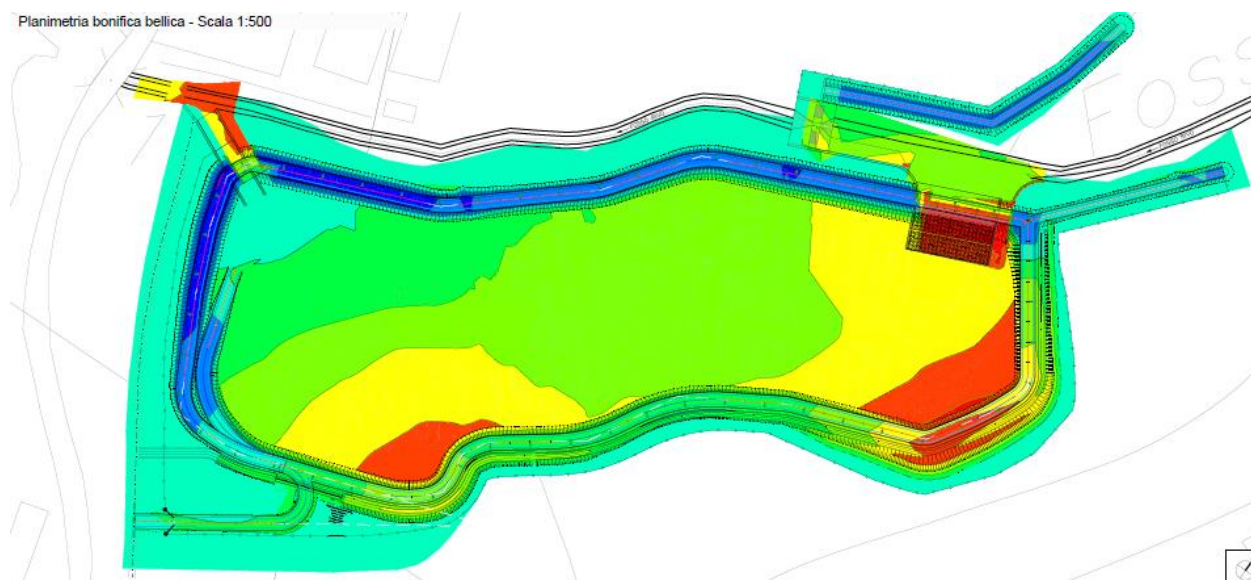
Stralcio Planimetria Bonifica Profonda Ordigni Bellici
